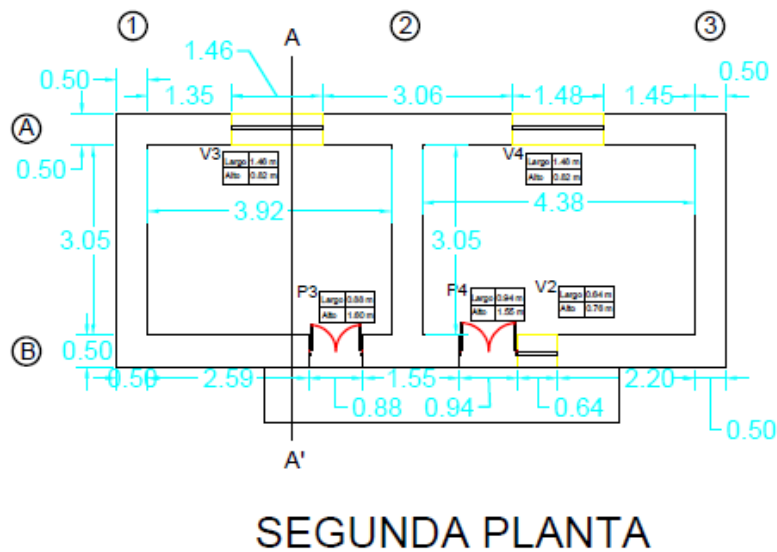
Configuración arquitectónica rectangular, plano en planta de la vivienda encuestada n° 08. Fuente: Elaboración propia, 2019.
